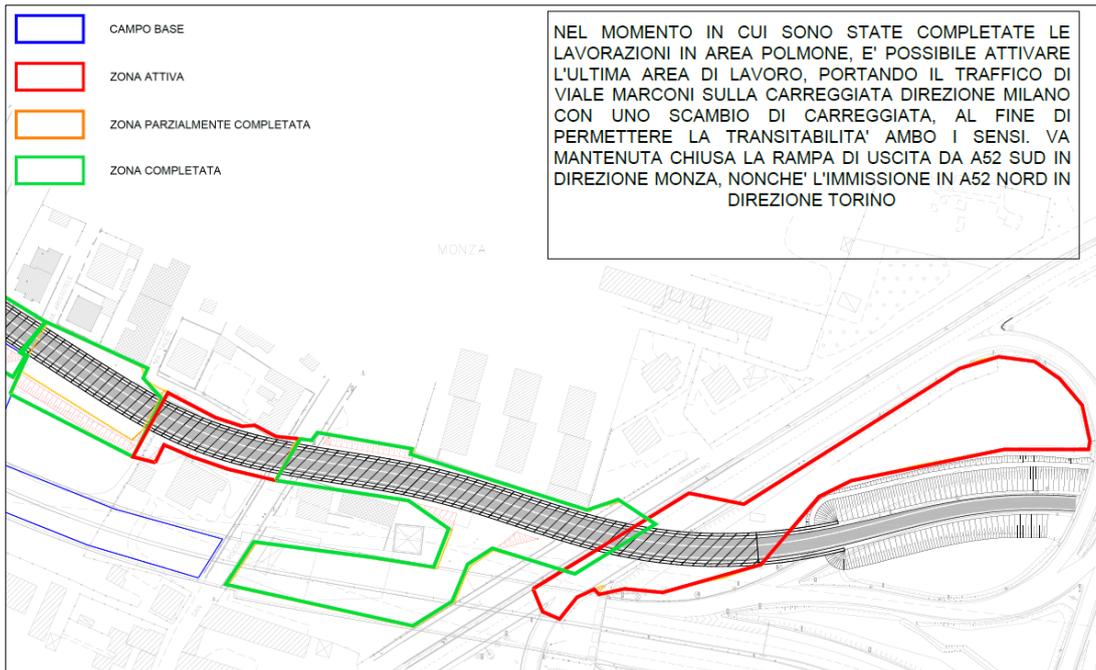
Fasi realizzazione copertura galleria del Piano di Sicurezza di progetto illustrativo della fase G di scavo della galleria.
